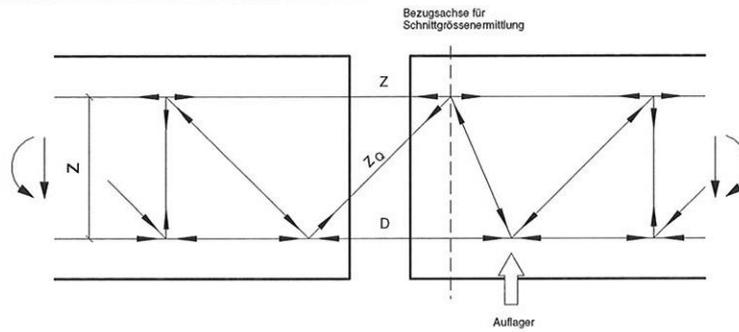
Egcobox Kragplattenelement Fachwerkmodell Typ P; P-D; P-DD
